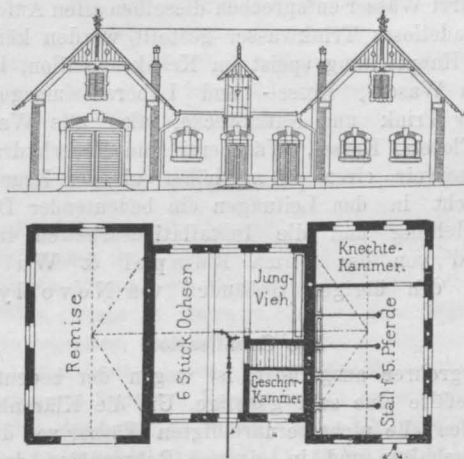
Ansicht und Grundriss des Ochsenstalles.
